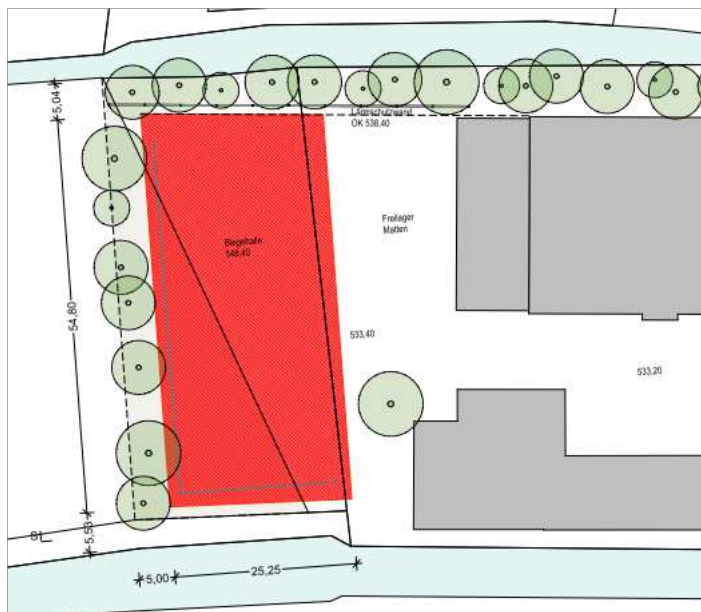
Geplante Lärmschutzwand (Detailausschnitt, Quelle: Kley Architekten, Biberach, Stand 28.03.2017)
